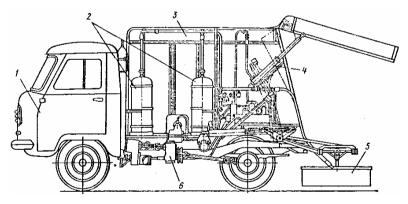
Самоходный асфальторазогреватель: 1 – кабина; 2 – газовые баллоны; 3 – кузов; 4 – гидроцилиндр подъема задней крышки; 5 – блок горелок; 6 – трансмиссия
